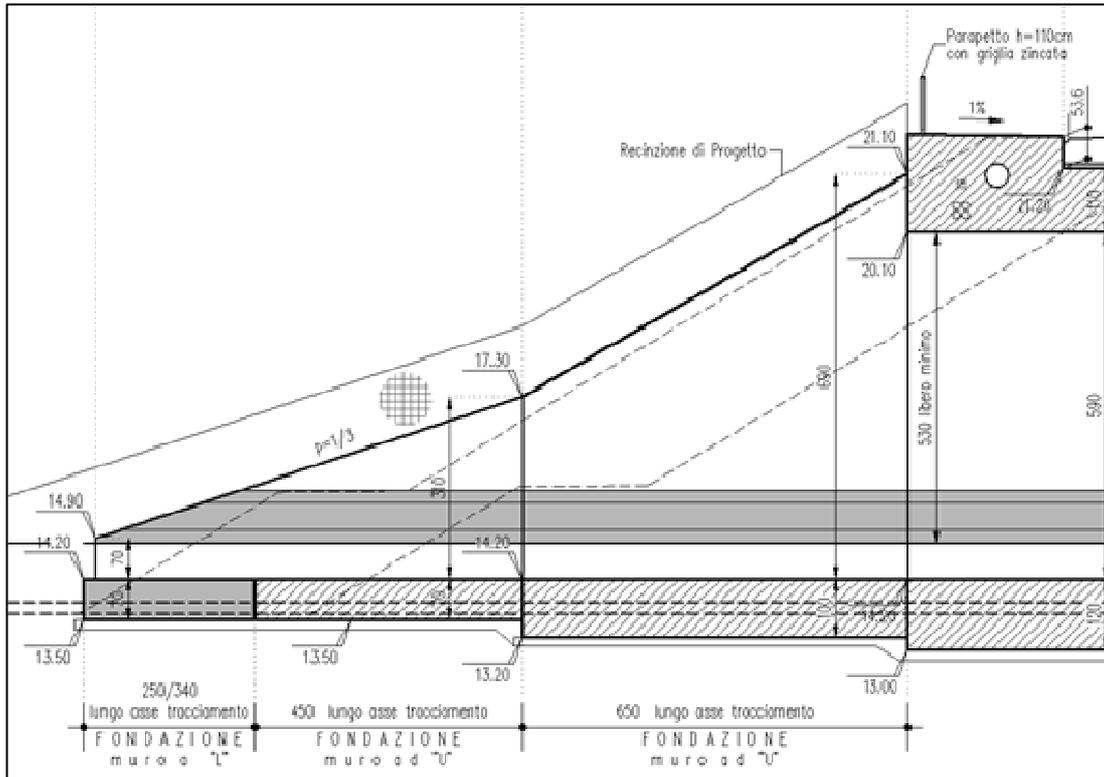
PARTICOLARE IMBOCCO SOTTOVIA
